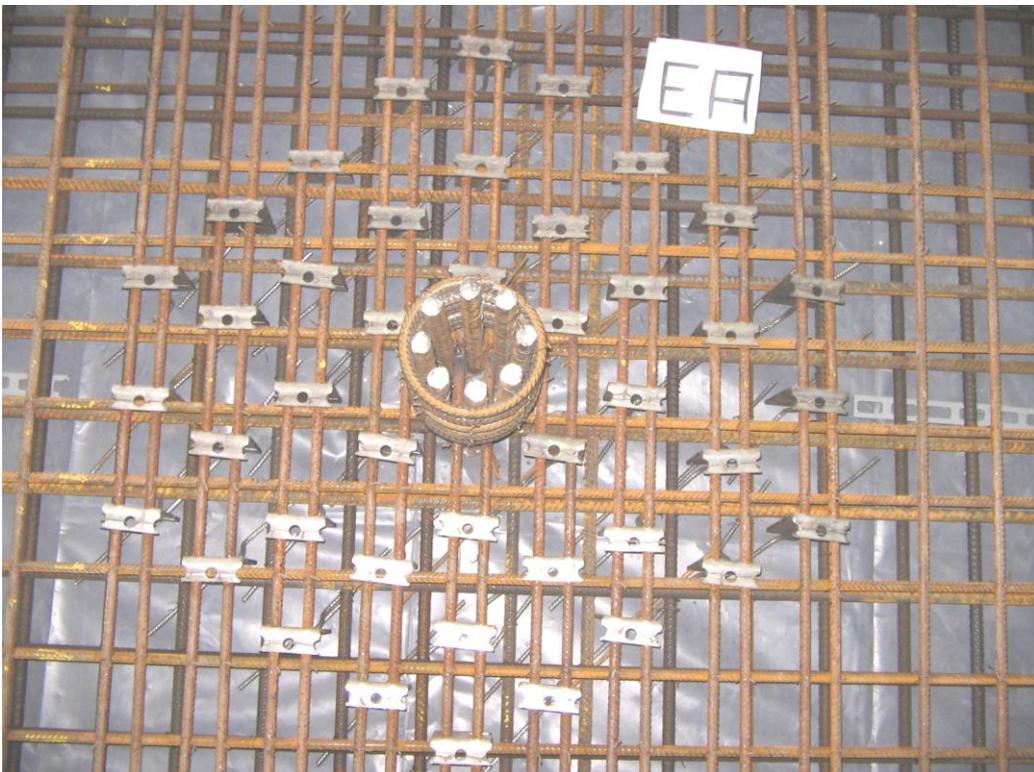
Untere Bewehrung mit Lage der Einbauteile – Versuchskörper EA
